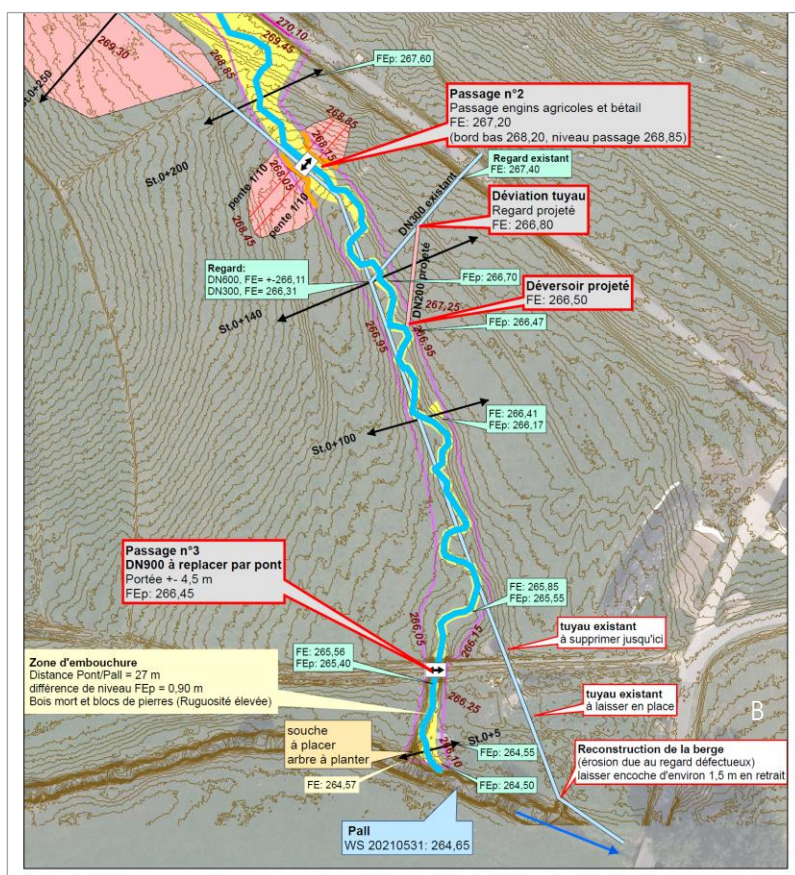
Aszug aus dem „plan de construction“ der Bachrenaturierung (o.M., genodert) Quelle: SICONA
